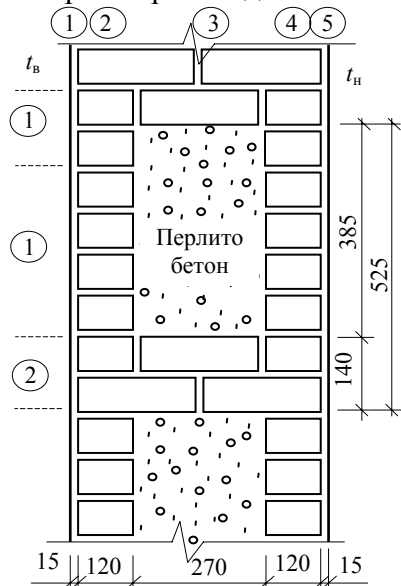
Разрез по кирпичной стене облегченной кладки (расчетная схема стены к примеру 5)
